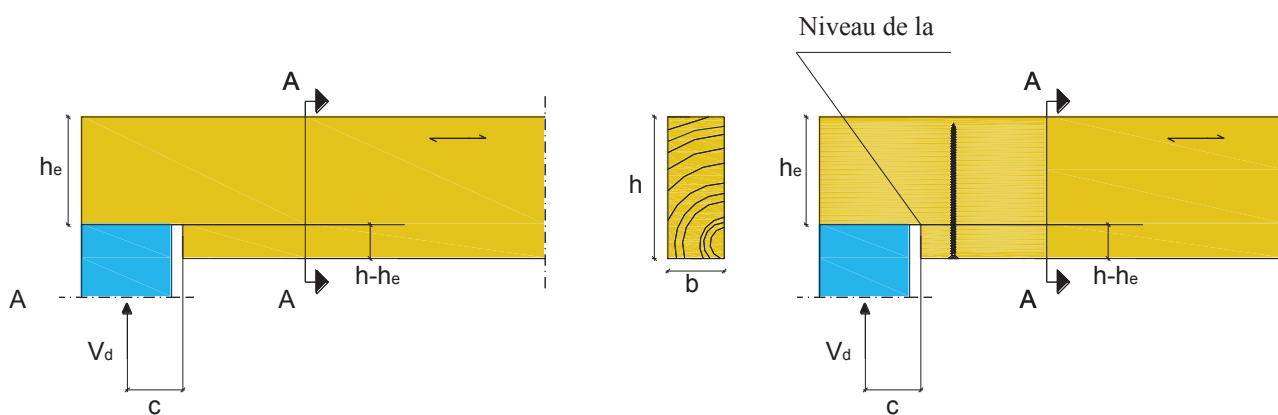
Exemple de renforcement en traction d'un appui de poutre entaillé
